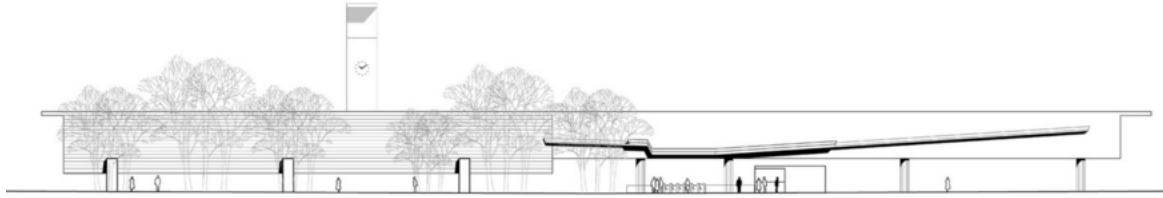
Elevación Fuente: Núcleo Arquitectura
